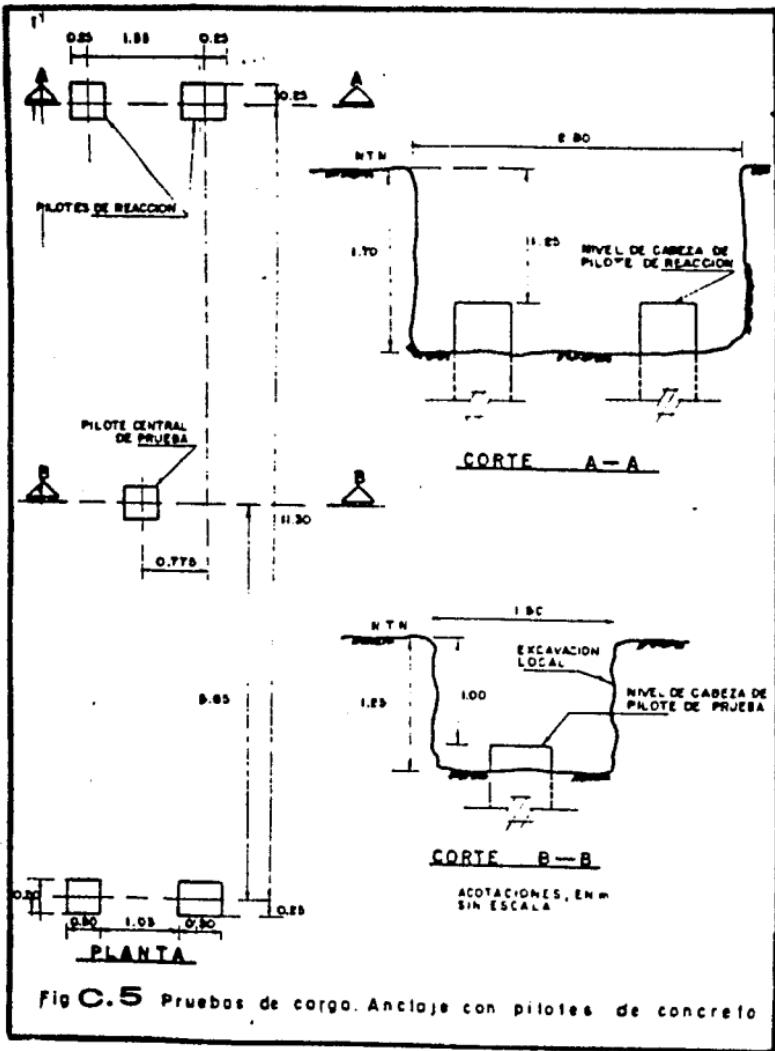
Pruebas de carga. Anclaje con pilotes de concreto
